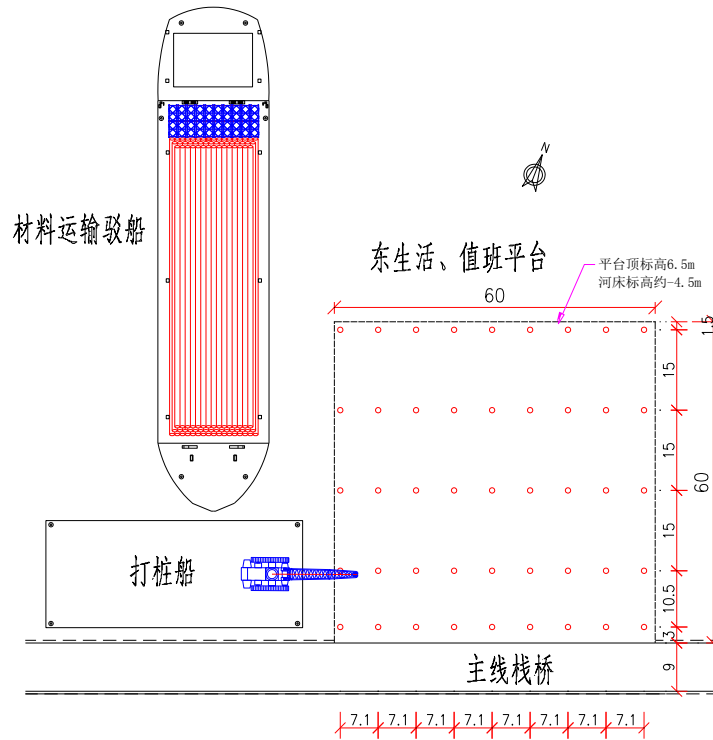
水上生活及办公平台施工平面图（尺寸单位：m）
